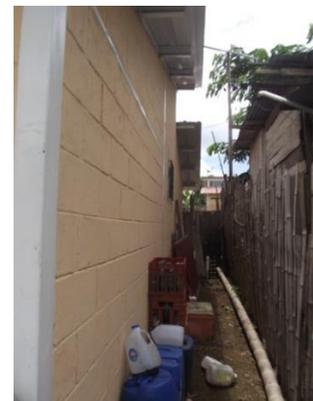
Fachada lateral izquierda vista desde el fondo
